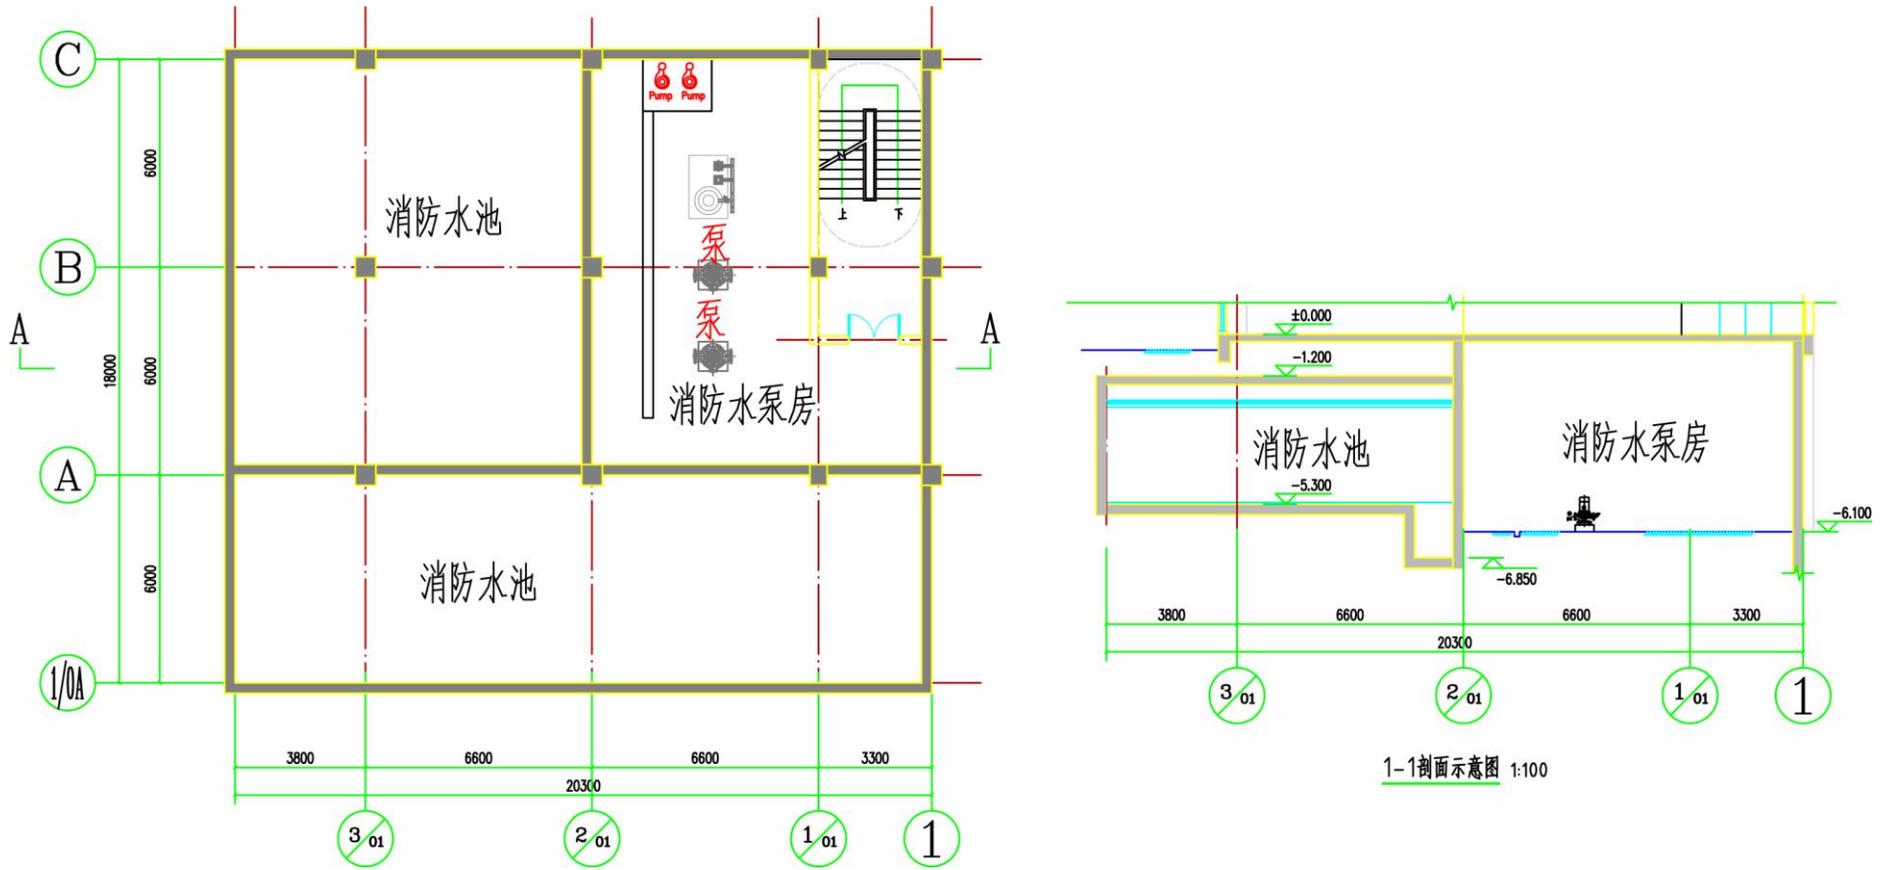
生产车间局部地下一层平面布置图及剖面图
